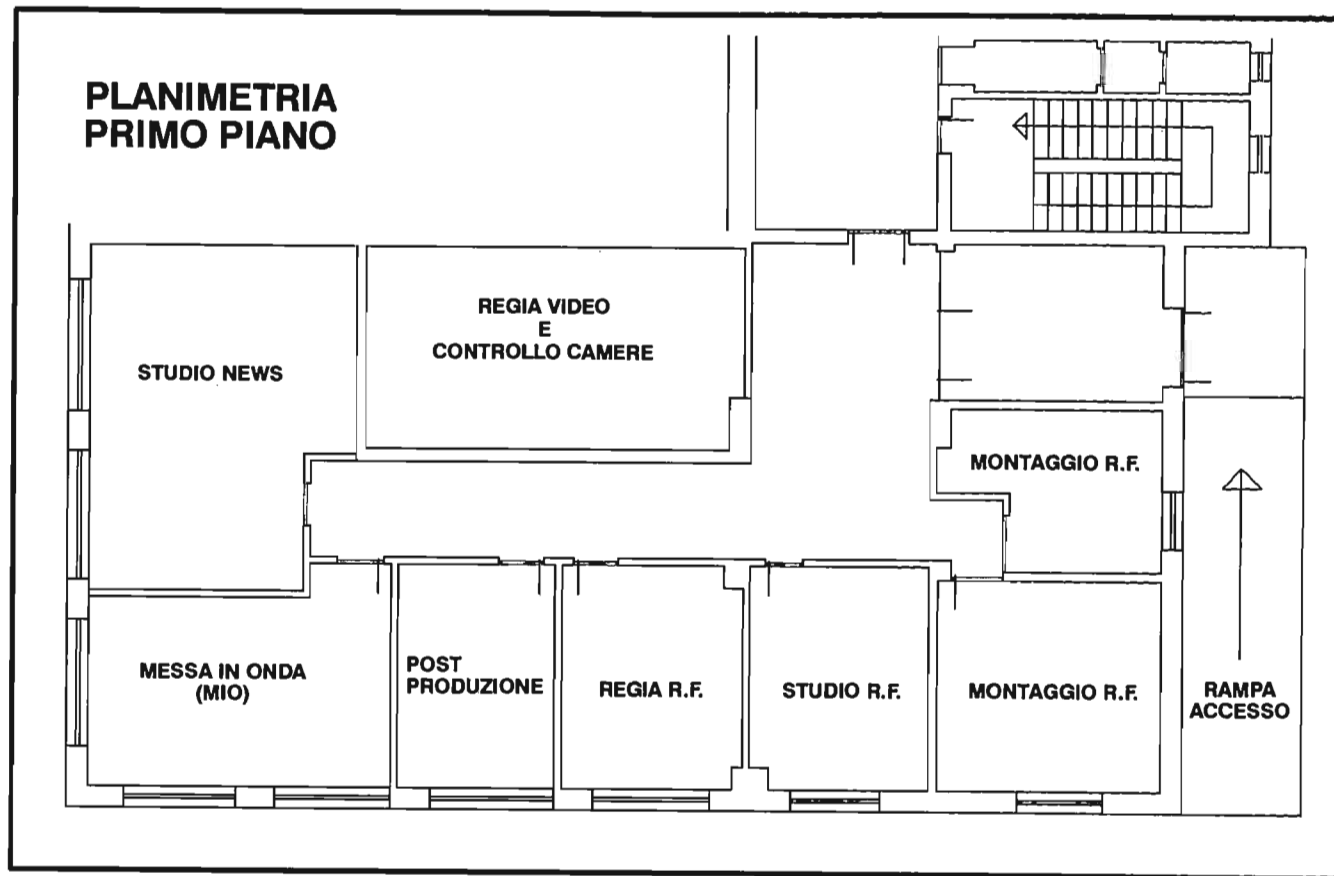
Disposizione delle strutture televisive al 1° piano della Sede.
